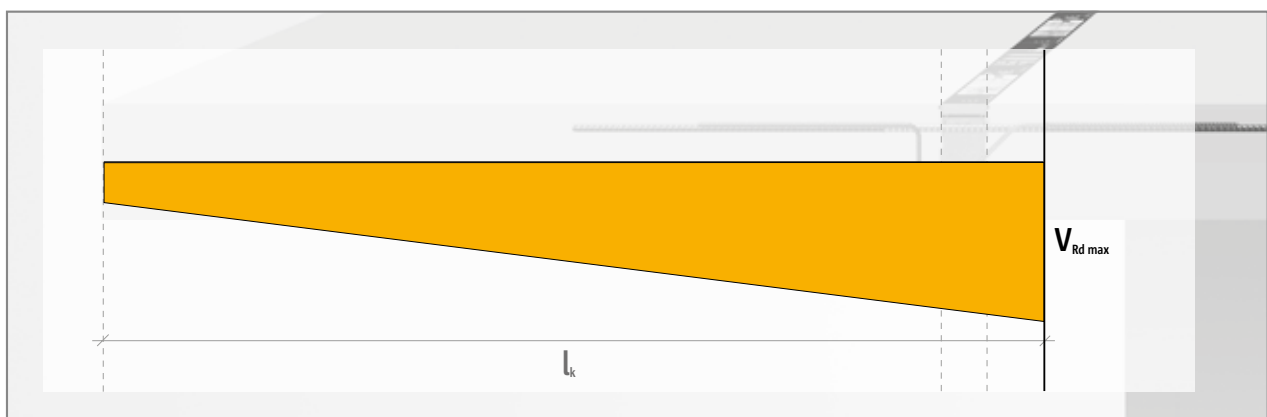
Schöck Isokorb® T typ KL: Předpokládané zatížení
